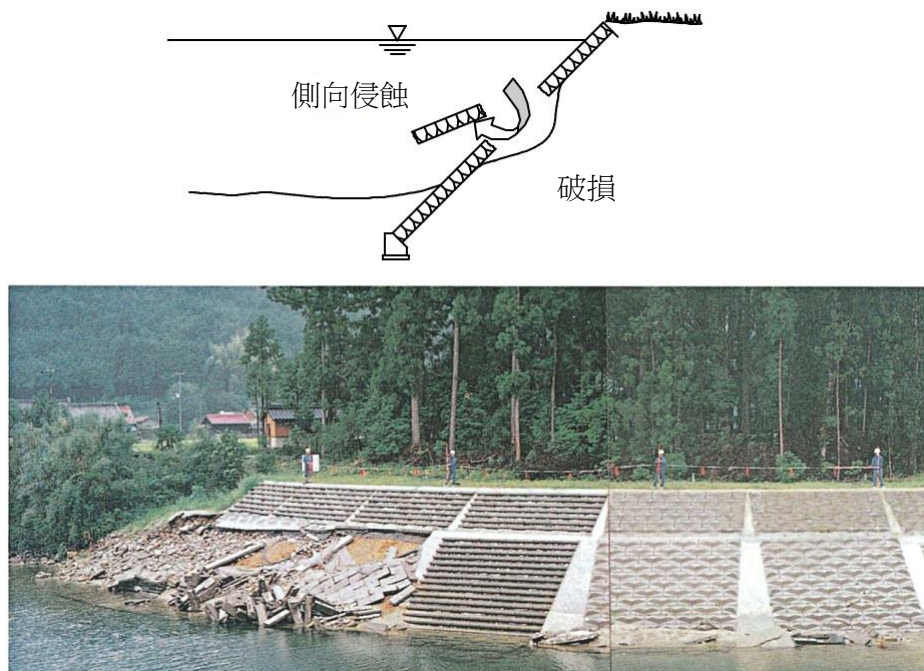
流體力造成預鑄混凝土塊毀損的災情案例
